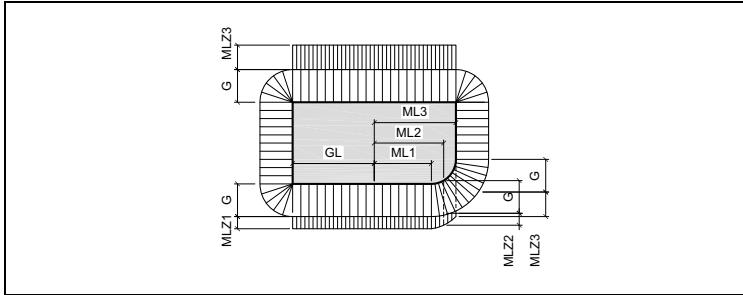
Grenzabstand bei gestaffelten Fassaden (§§ 21–26 ABV)
